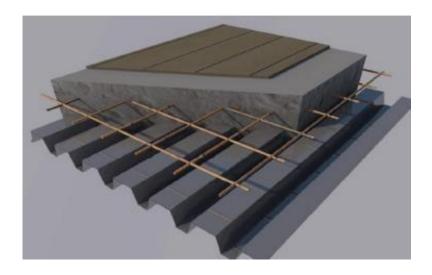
les composants du plancher collaborant / Source: http://www.guidebeton.com
